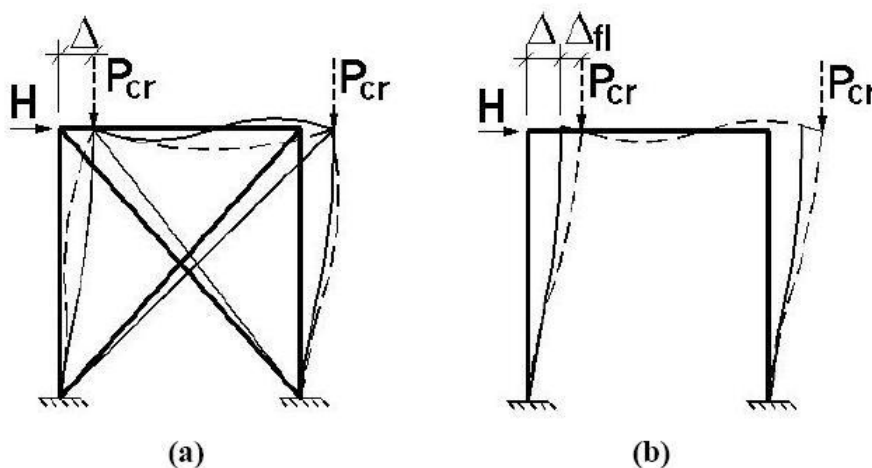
Pórtico contraventado a) e pórtico não contraventado b) (Silva, 2007).
